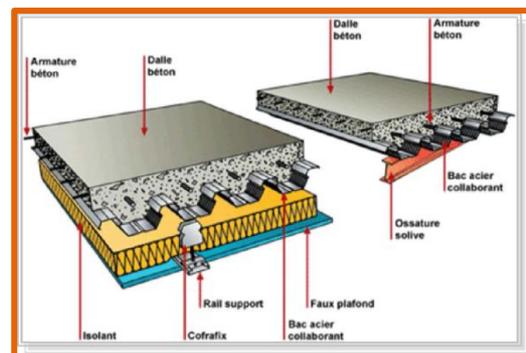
Détail sur les plancher collaborant *Source : cour structure S9
